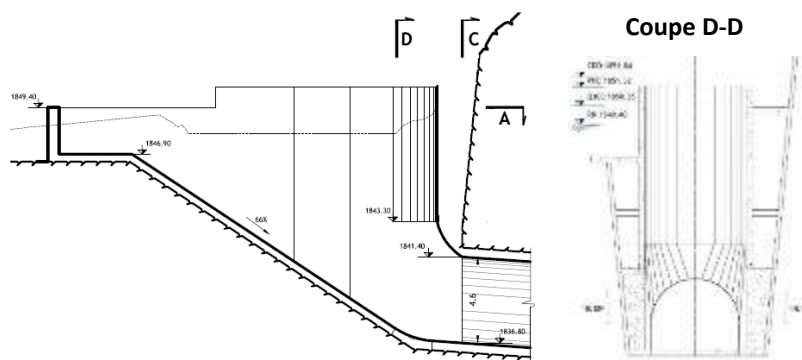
Coupes sur l'ouvrage d'entonnement avec structure béton
